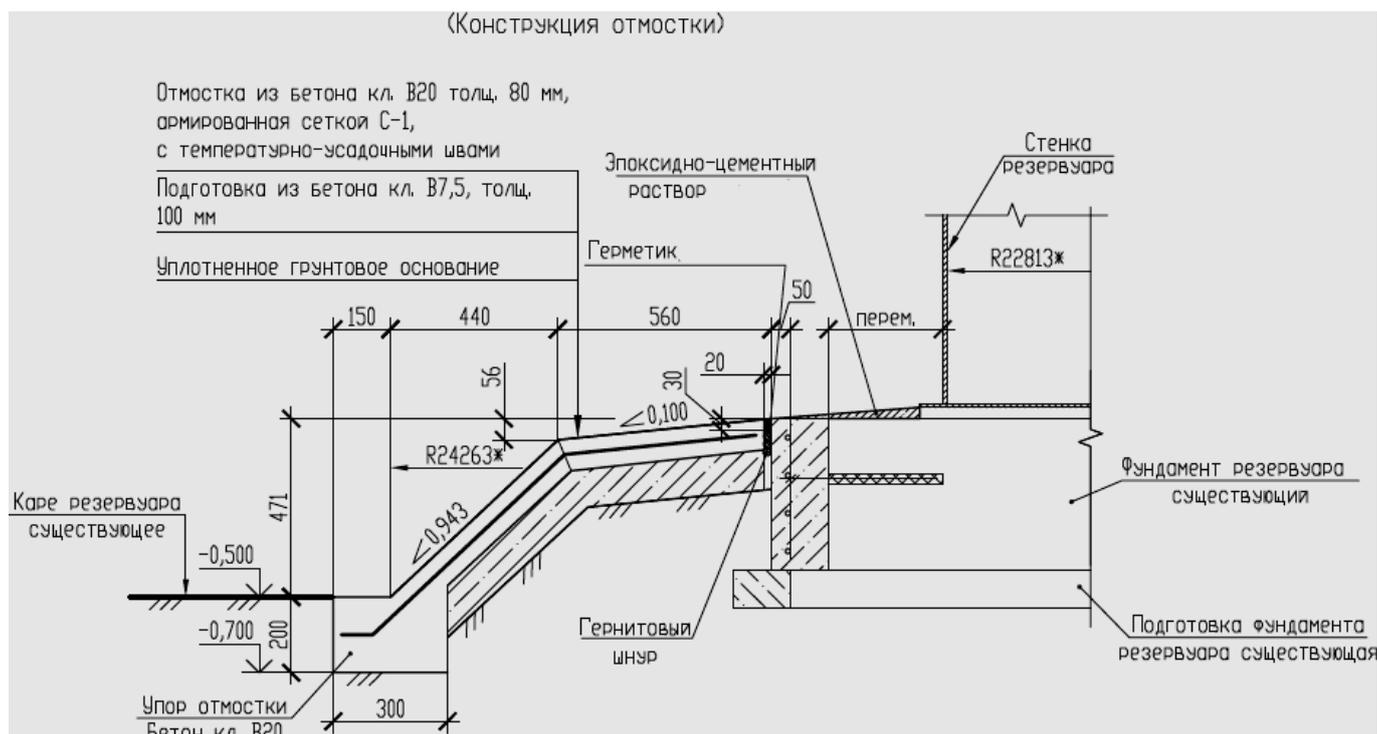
Конструктивное решение отмостки железобетонного фундамента нефтяного резервуара объемом 20000 м³
